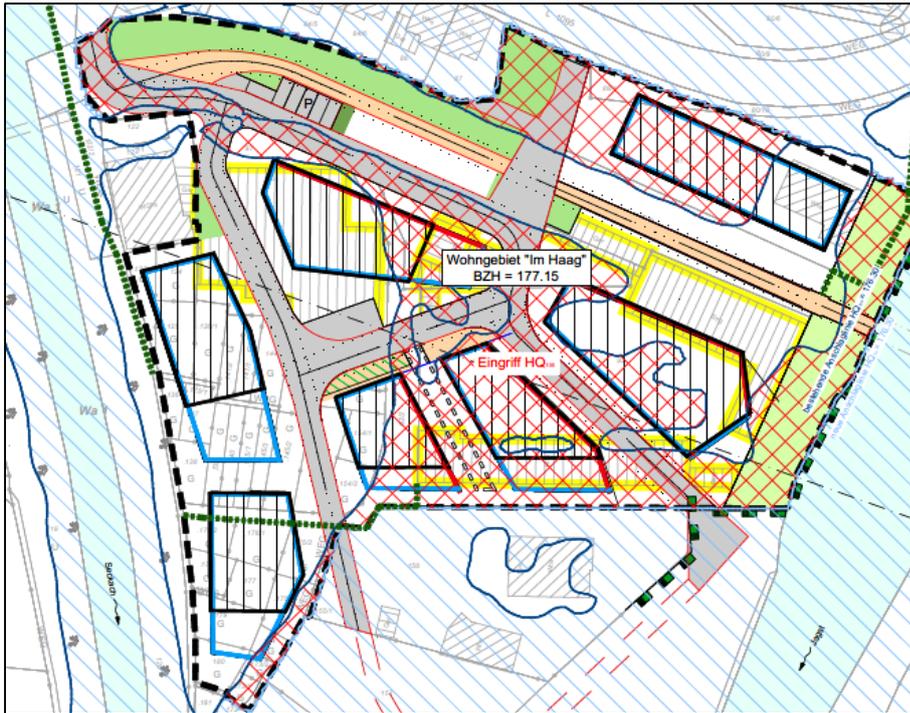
Lageplan Wohngebiet „Im Haag“ mit Eingriffsflächen
